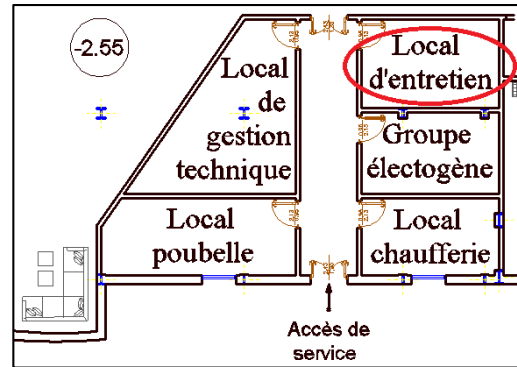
(3.1.9.2) : Emplacement local d'entretien - Plan Rez De Jardin.
